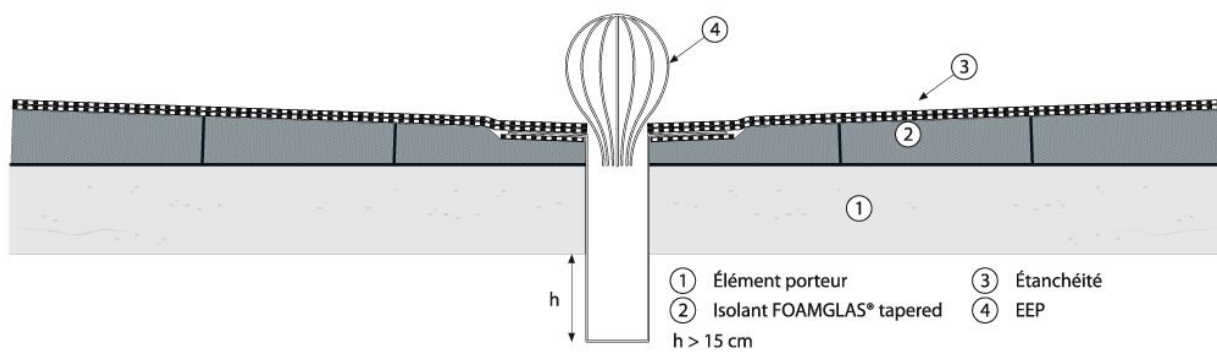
Coupe sur une Entrée d'Eaux Pluviales (EEP)
